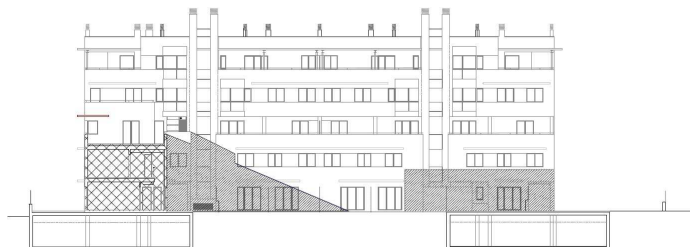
Soleamiento de la fachada más desfavorable el 22 de diciembre entre las 15 y las 16 horas
